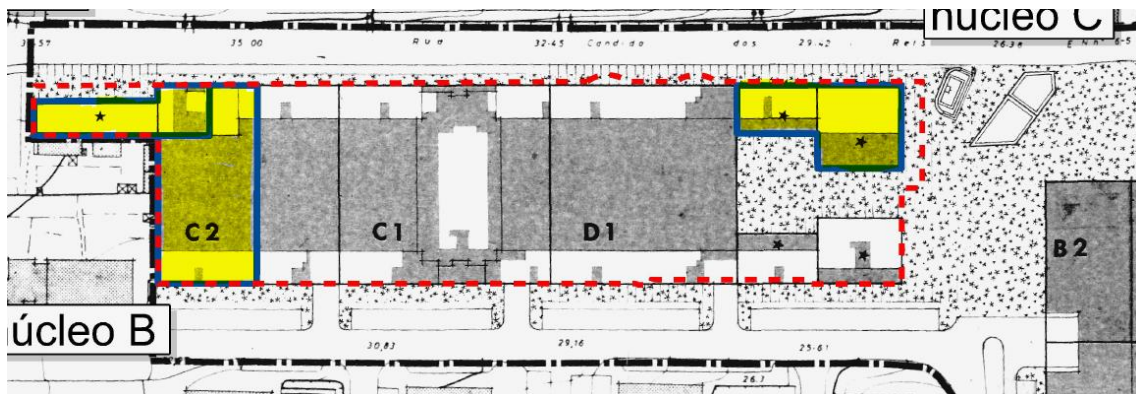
Planta de Implantação do Plano de Pormenor do Espargal.
